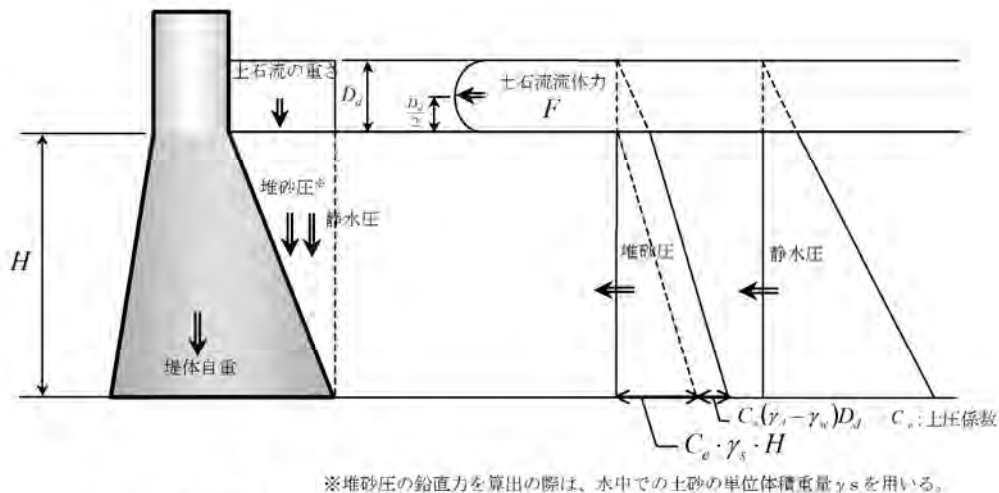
不透過型砂防堰堤 非越流部の設計外力図
